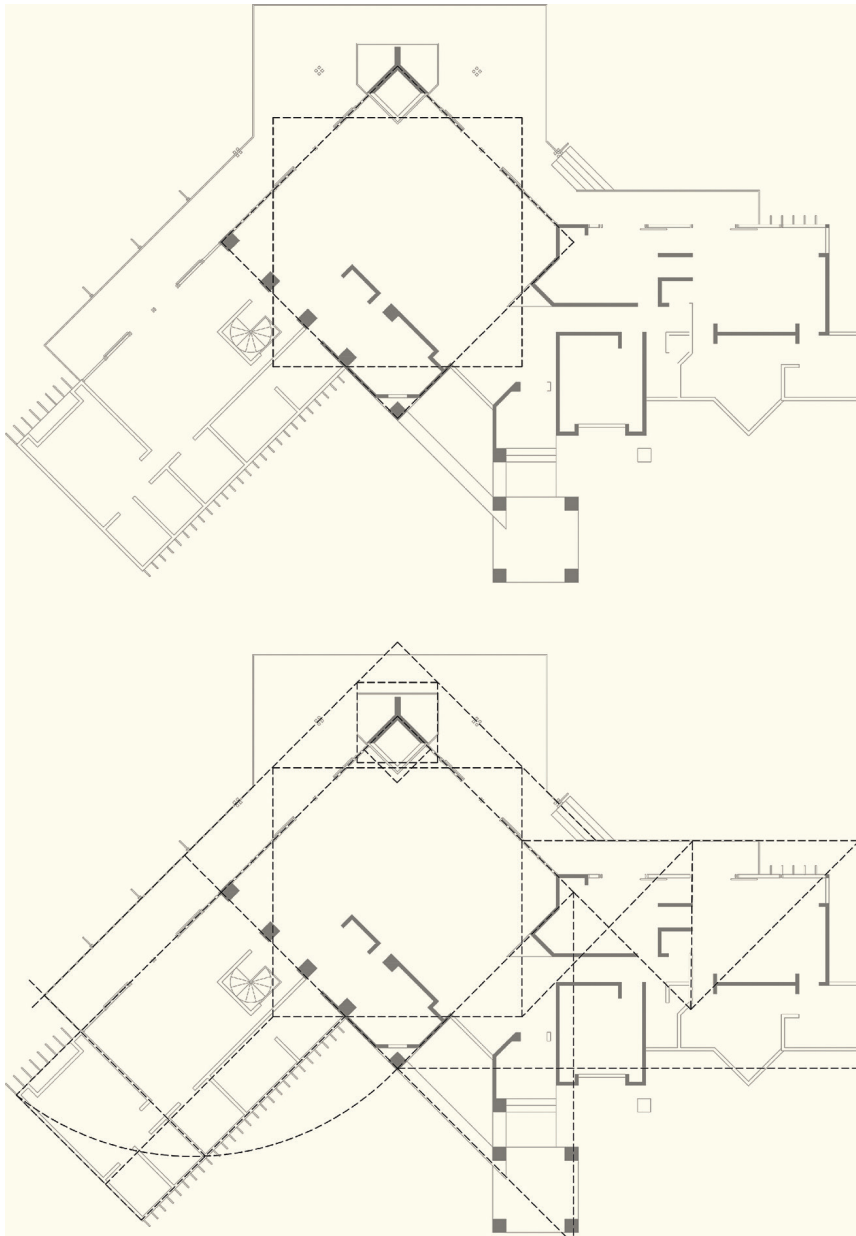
Dibujo sobre la planta arquitectónica de la casa Spinelli.
